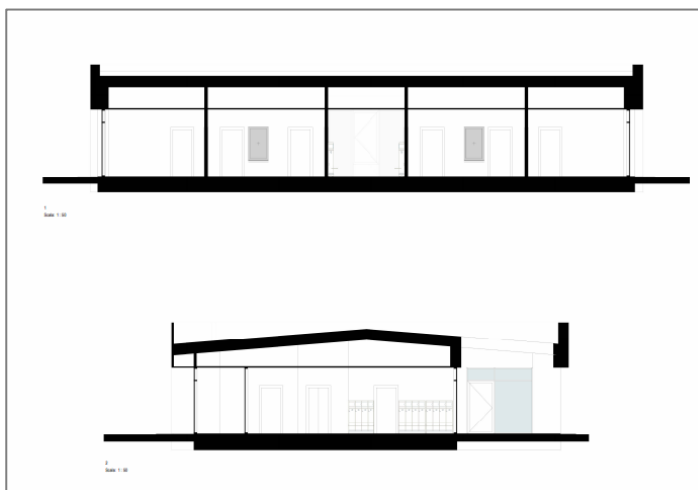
Sezione trasversale e longitudinale dell'edificio in progetto
